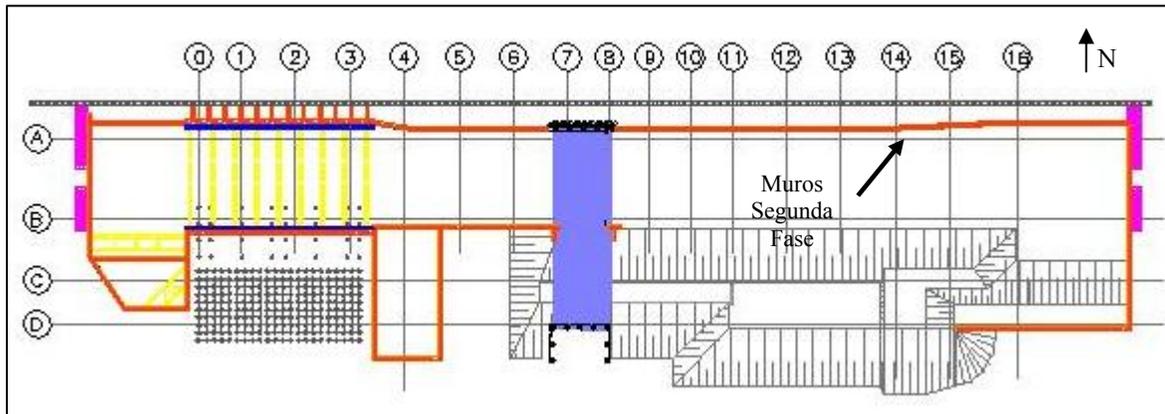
Planta de ejecución de segunda fase de muros colados.
